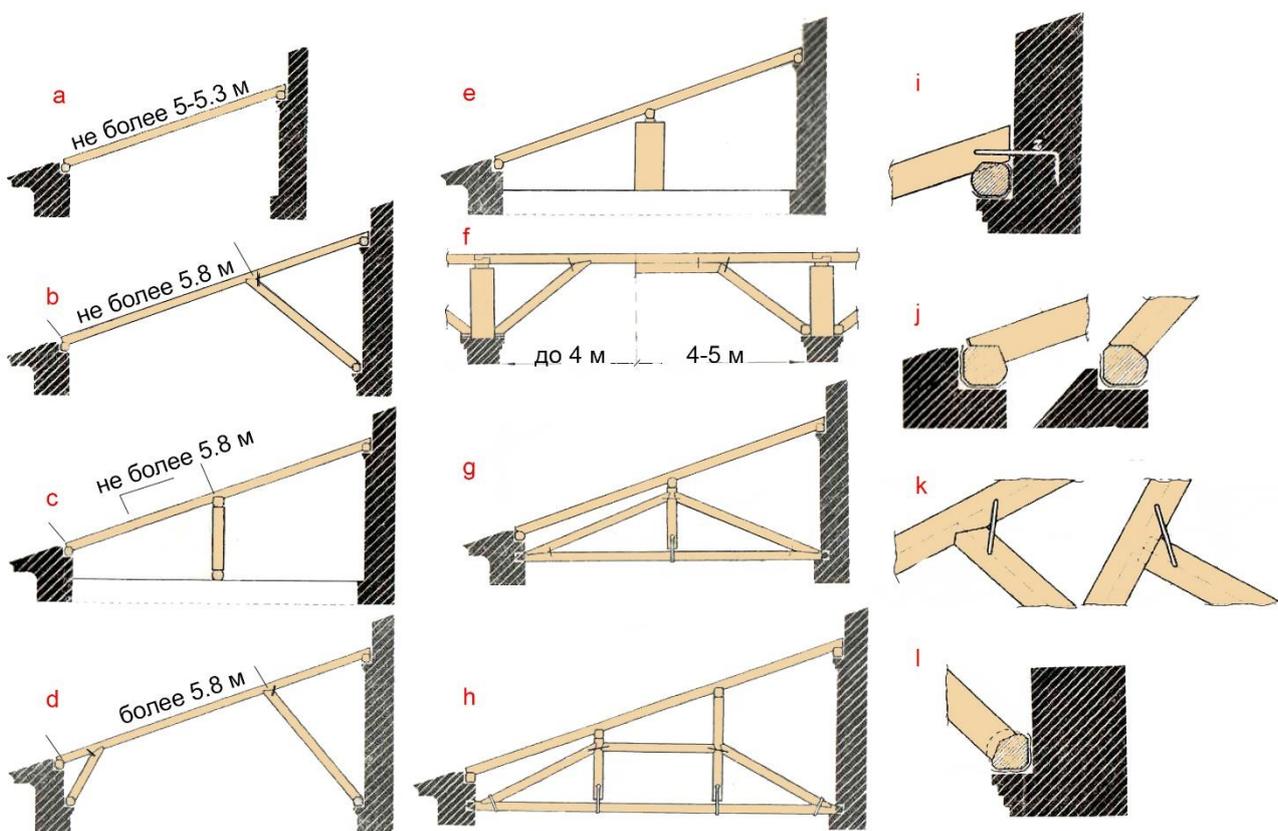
Наслонные стропила односкатных крыш: а – стропила малого пролета с опиранием на стены; б – стропила с промежуточной опорой в виде подкоса; с – то же с опорой в виде промежуточного прогона на стойках; д – стропила большого пролета с двумя промежуточными опорами в виде подкосов; е – то же с промежуточной опорой на прогон по кирпичным столбам; ф – организация дополнительных опор промежуточного прогона при большом шаге поперечных несущих стен; г – организация промежуточной опоры стропильной ноги с помощью висячей ферменной системы; h – организация двух промежуточных опор стропильной ноги с помощью висячей ферменной системы; l – опирание стропильной ноги на верхний мауэрлат врубкой с анкерровкой в кладку; j – варианты опирания стропильной ноги на нижний мауэрлат врубкой; k – варианты
